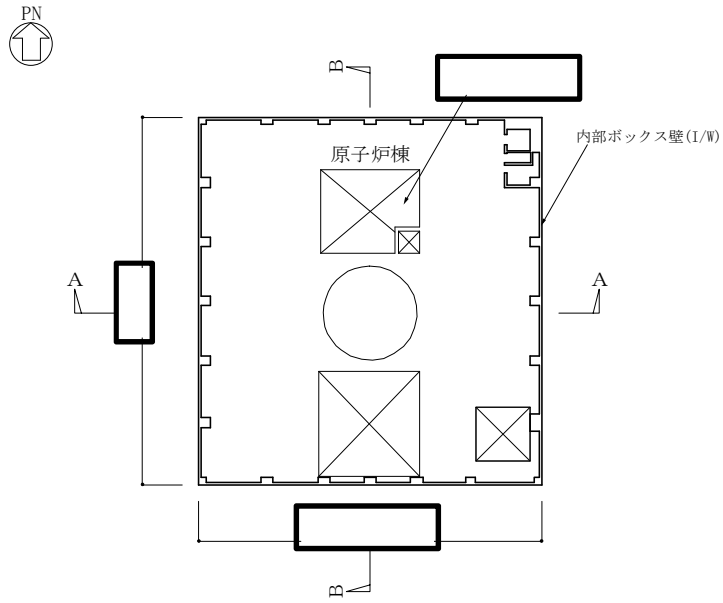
(9/10) 原子炉建屋の概略平面図 (EL. 46.5 m)
